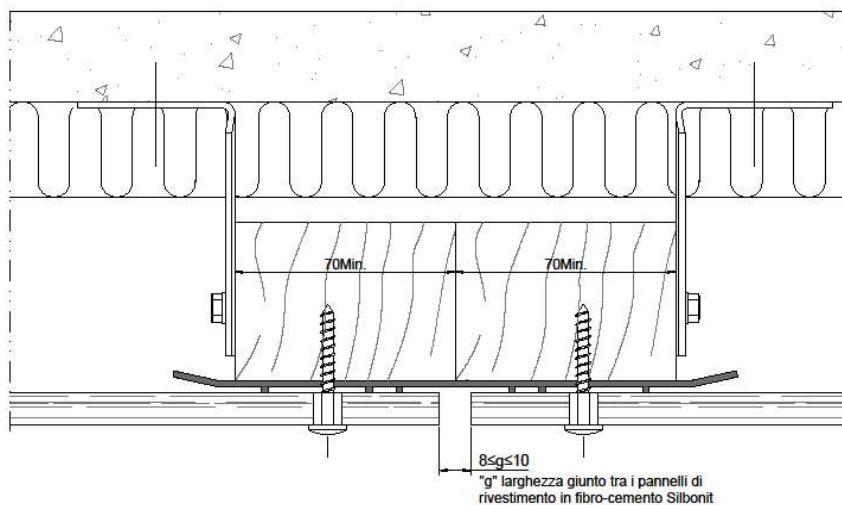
Esempio di una sezione orizzontale tipo del pacchetto di facciata ventilata in corrispondenza di un giunto verticale tra lastre. Si noti la presenza della guarnizione di protezione e la larghezza minima dei montanti di legno.
